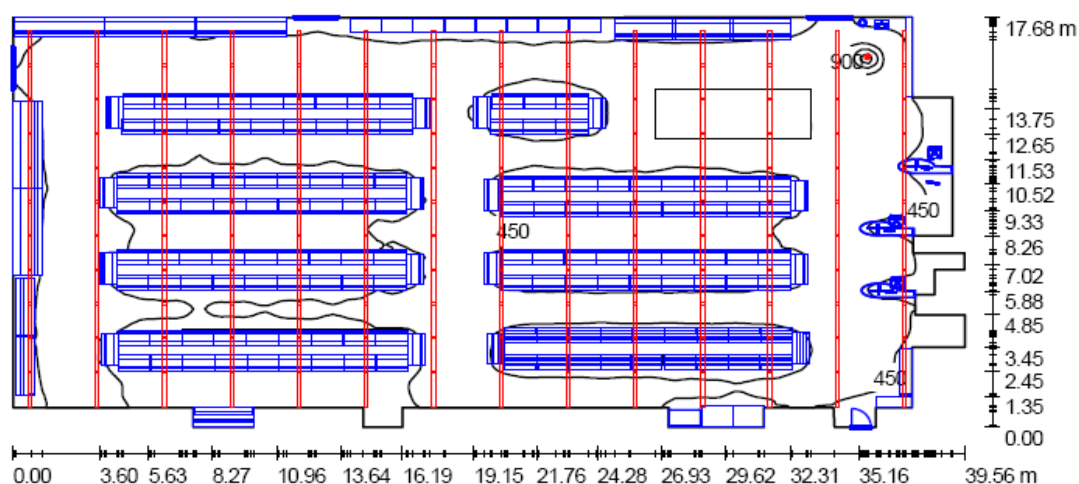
Planta geral plano X-Y da Zona de Vendas.
